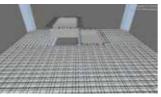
BIM技术模拟 预制混凝土卫生间降板吊装
